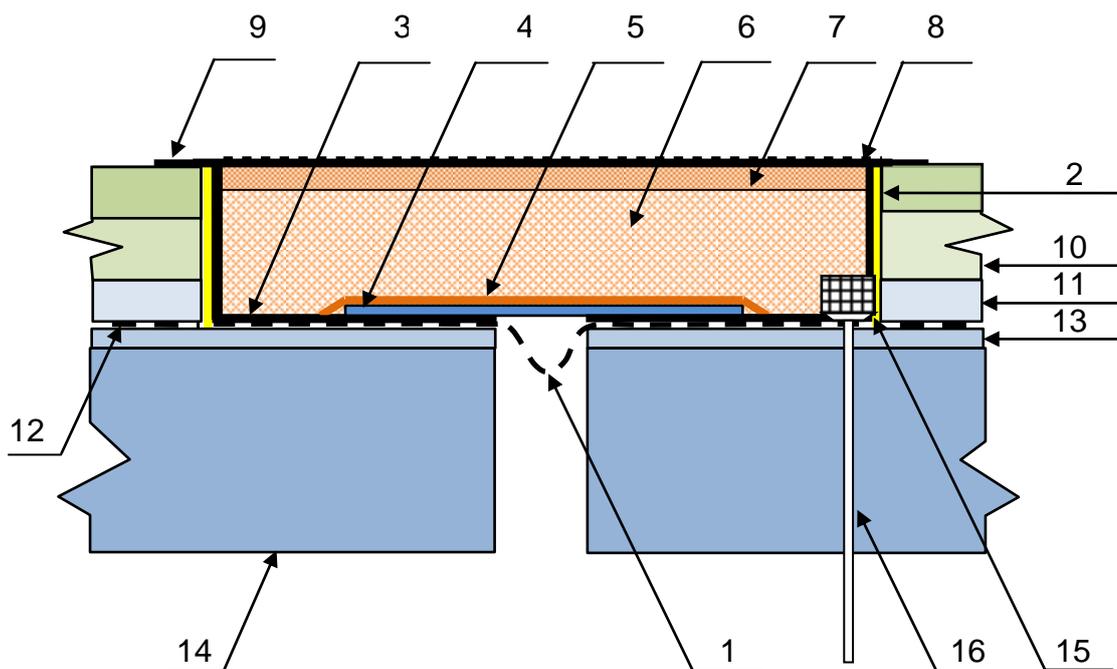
Рекомендуемая конструкция ЩМДШ при поврежденном слое гидроизоляции и защитном слое
